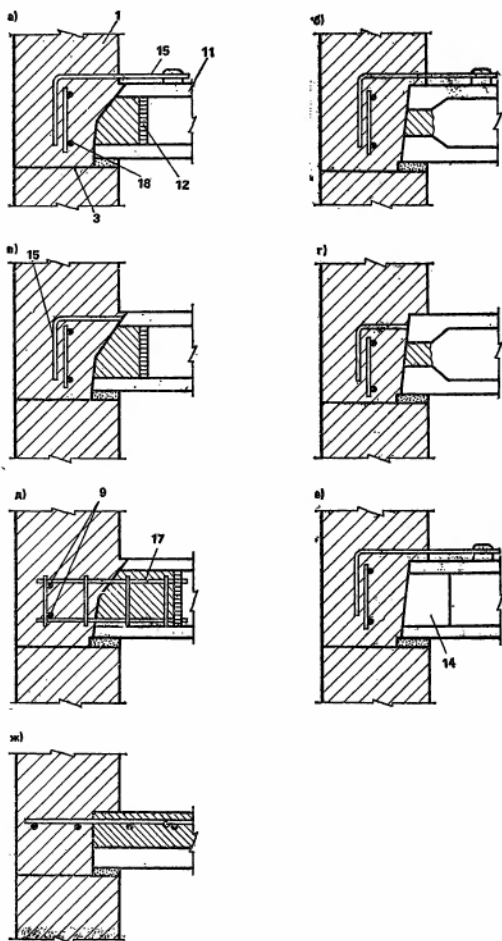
Комбинированные узлы наружных монолитных стен со сборными многопустотными и сборно-монолитными перекрытиями (1—18—см. рис. 16, 18, 19)
